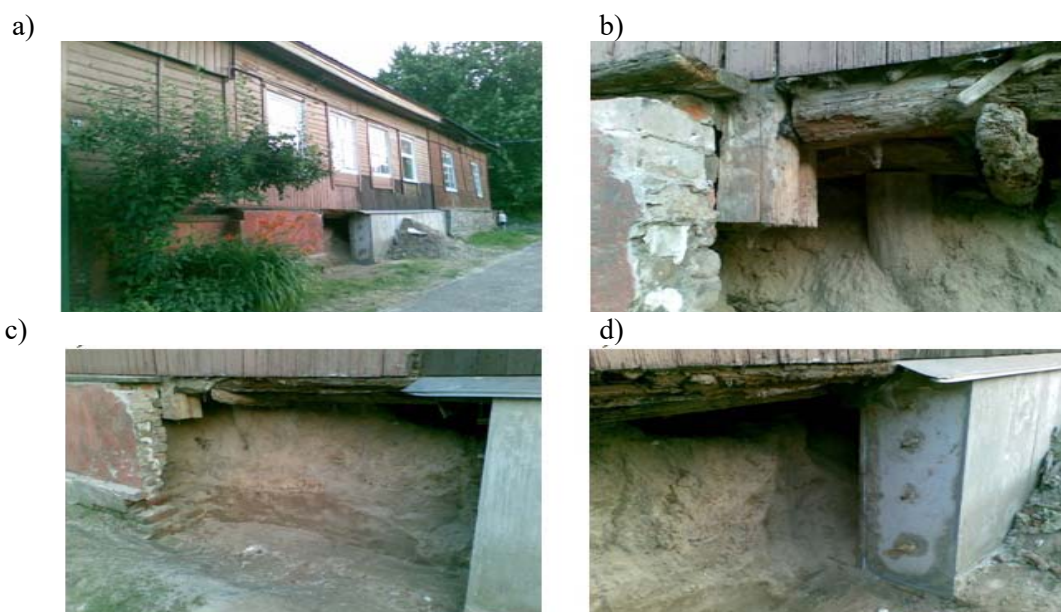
Заміна старого цегляного фундаменту на залізобетонний по вул. Малясова в Чернігові.
